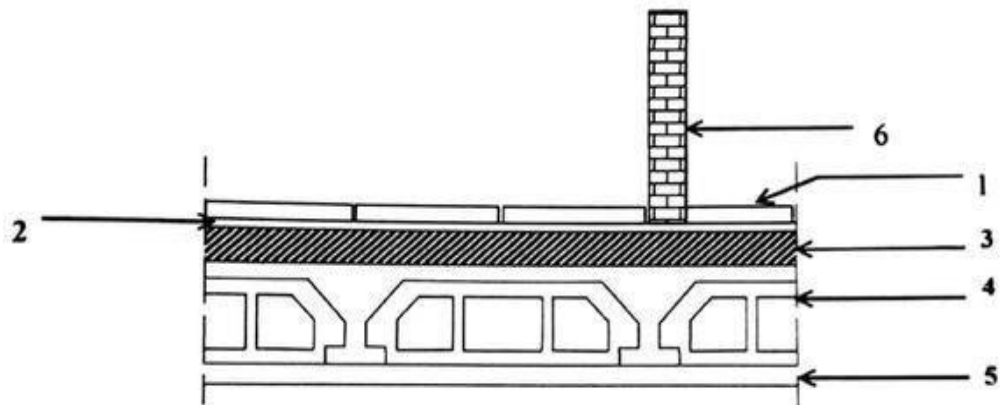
Coupe verticale du plancher courant à corps creux.
